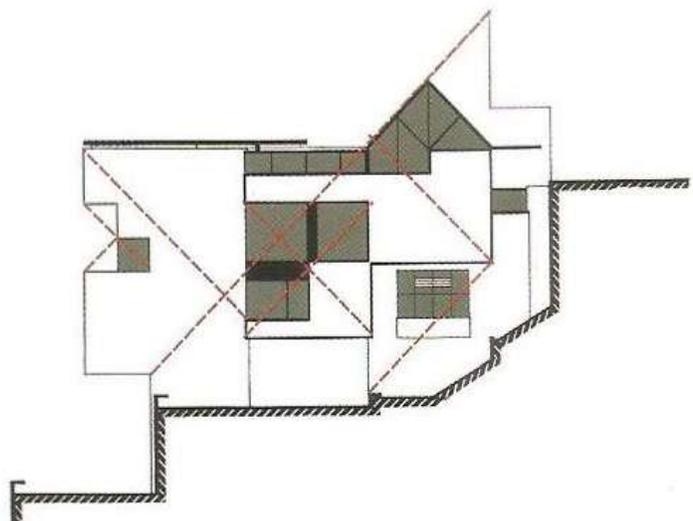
Traçado regulador da fachada da casa do arquiteto. Fonte: BORSOI, 2006, p. 45.
